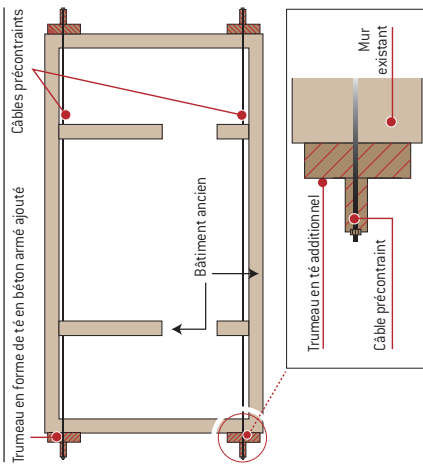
Exemple de renforcement par ajout de murs en béton à l'extérieur + serrage par précontraint (vue en plan)
